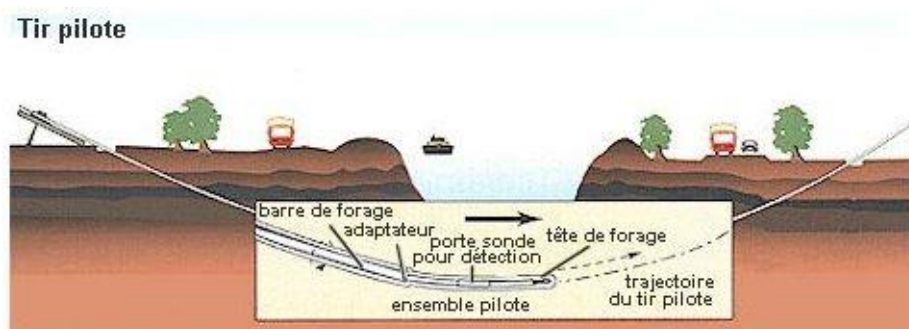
Exemple de tir pilote pour forage dirigé horizontal (Source : CEDERIS)
